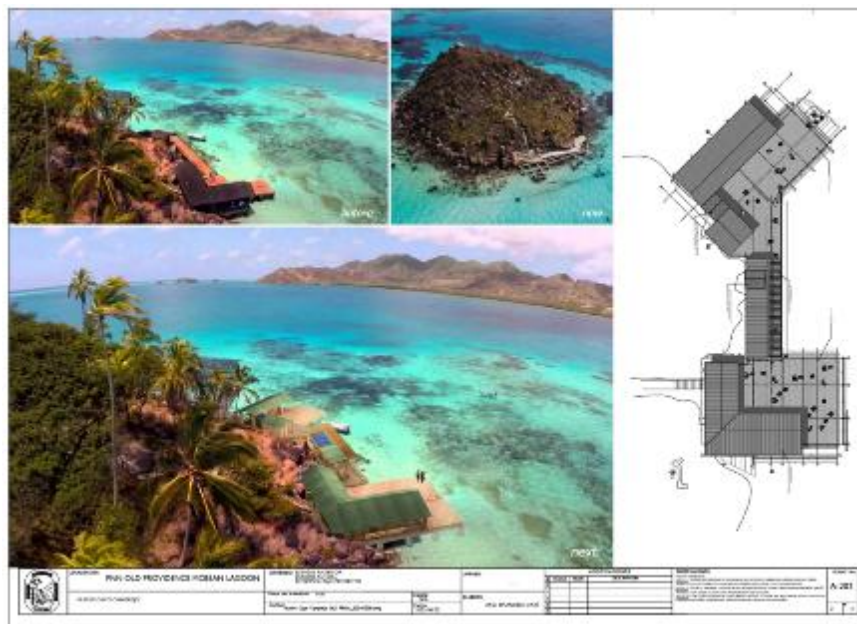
y 10: Collage imágenes Cayo estado actual y propuesta Fuente: Información arquitectónica GI - PNNC
